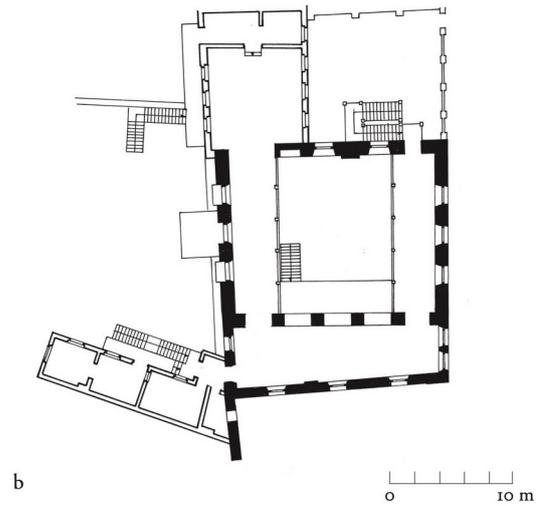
Grundriss 1. OG #1 von 2018
